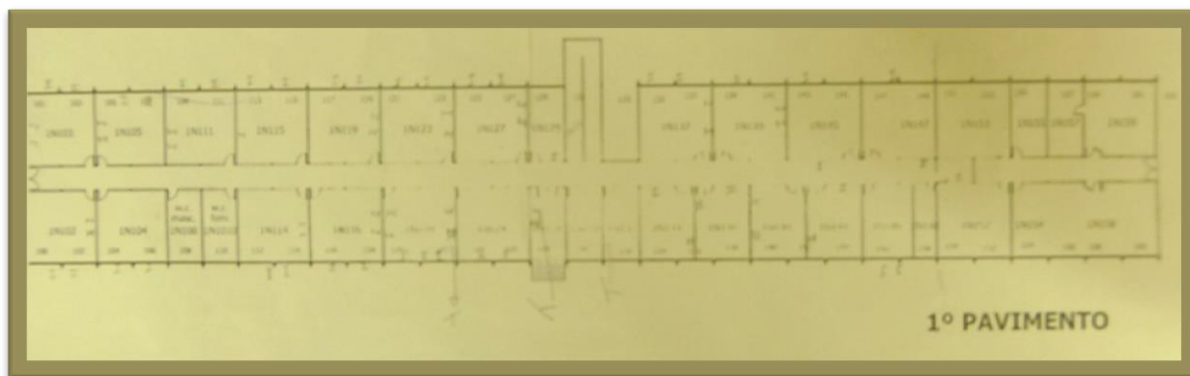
Planta do primeiro pavimento da Escola Apuã (Educação Infantil)
